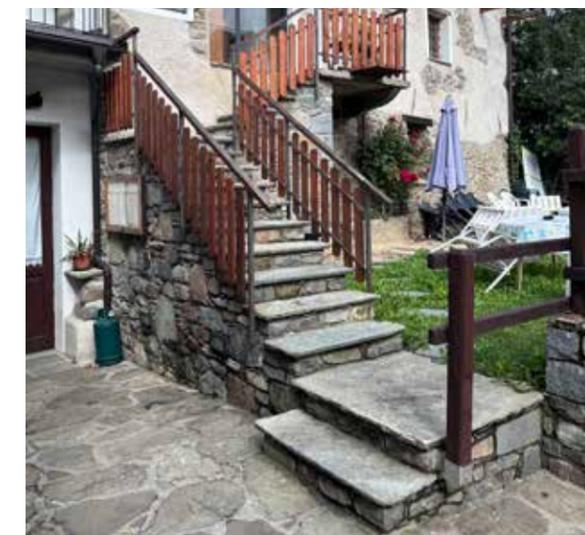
Dettaglio prospetto Sud-Est, edificio
